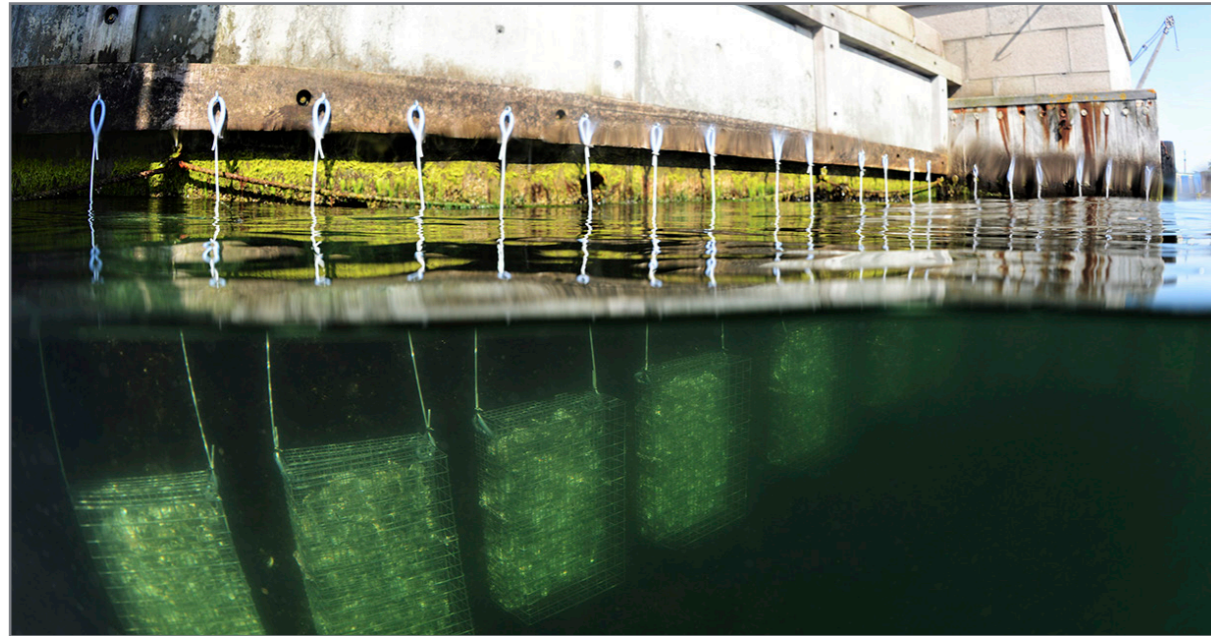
Betongelement som fungerar som hållkar och vågbrytare. Foto: ECONcrete.
